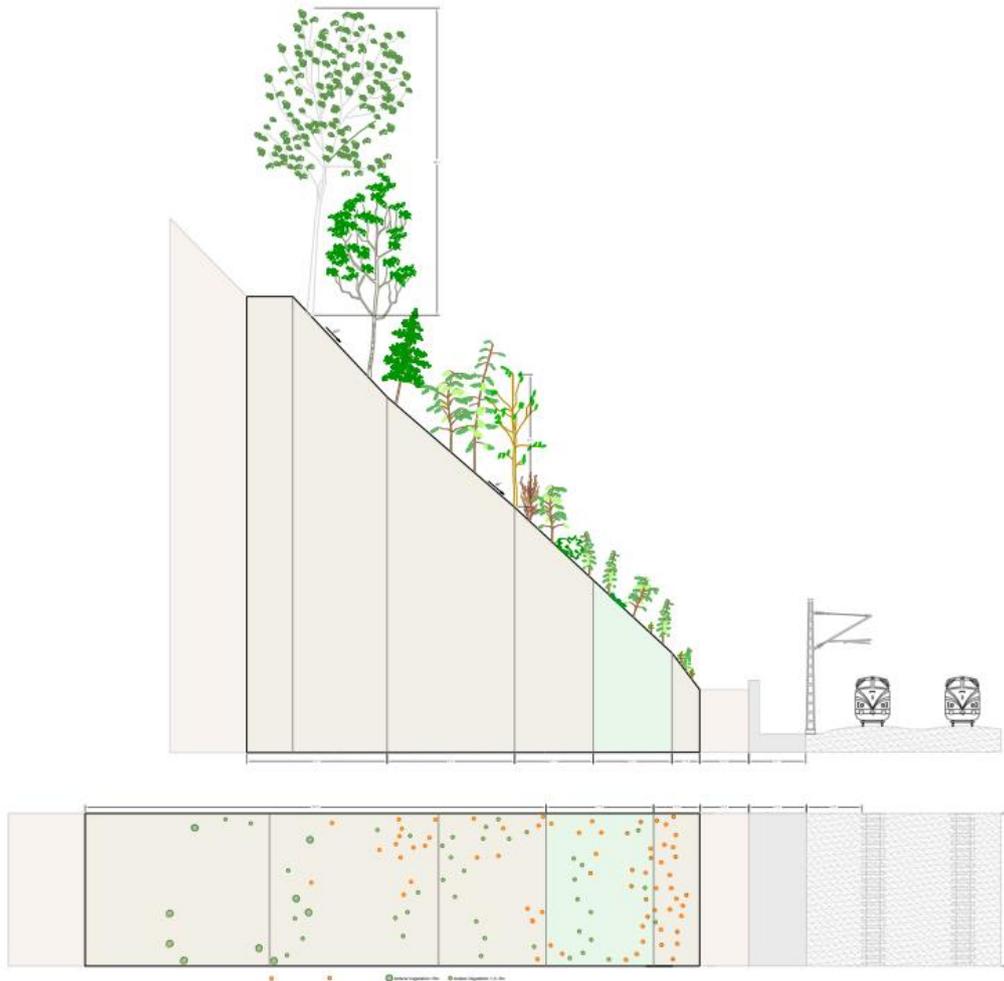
Fläche 11.2 – Querschnitt und Grundriss.
